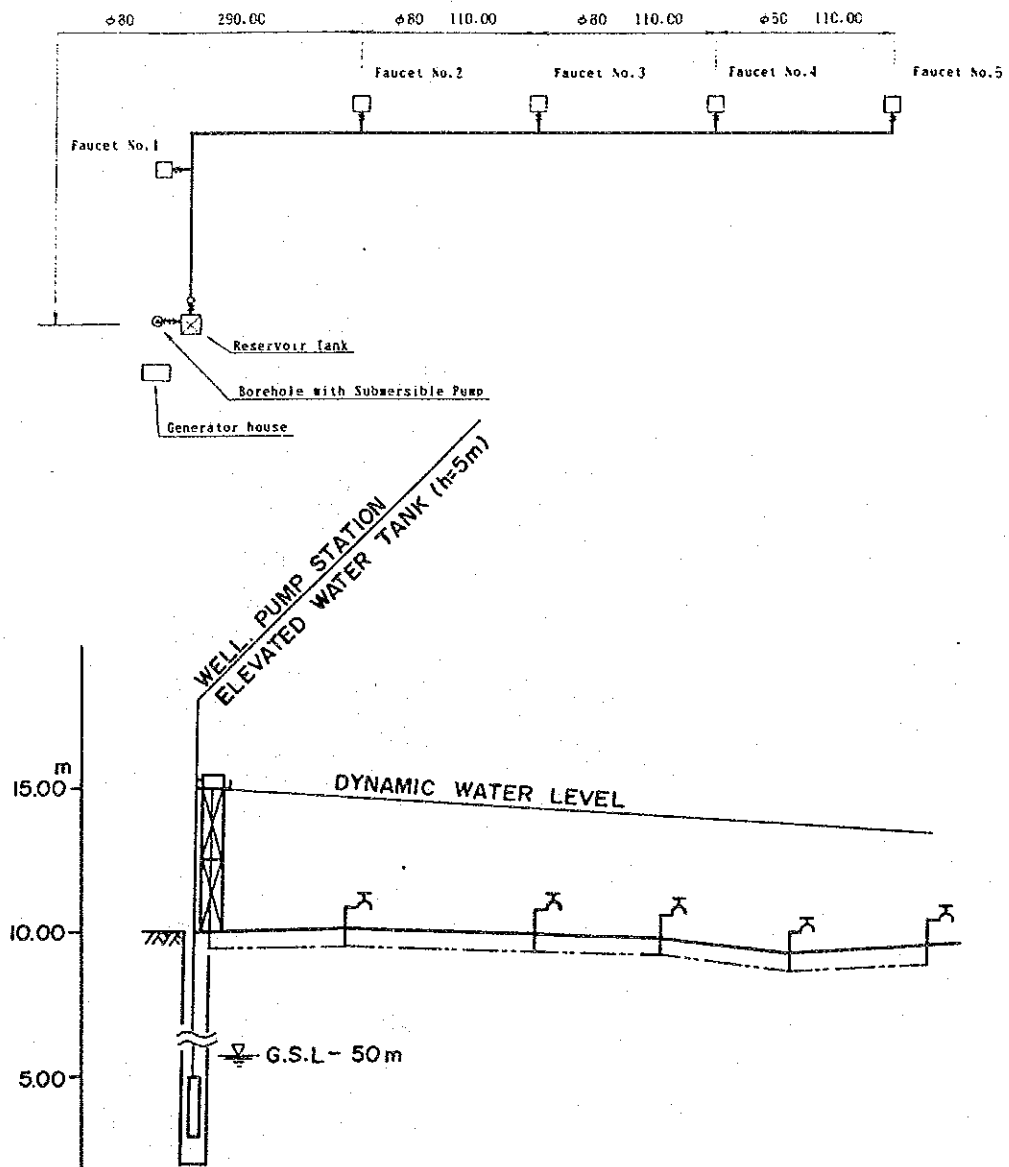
給水施設配置図 No. 4 ルワン・ボレ村
